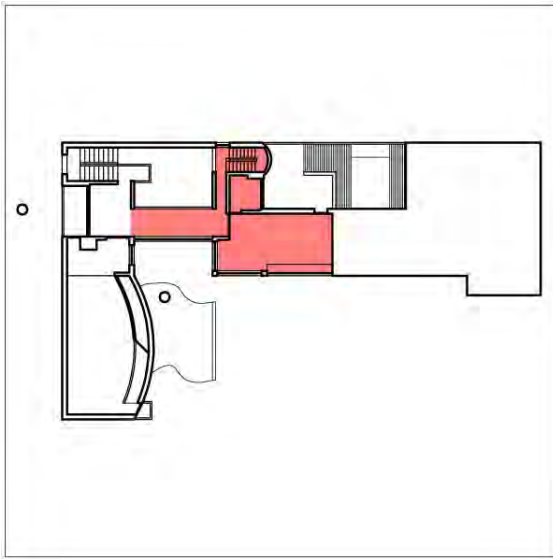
Villa La Roche, Planta de localização da zona de habitação (Ilustração nossa)
